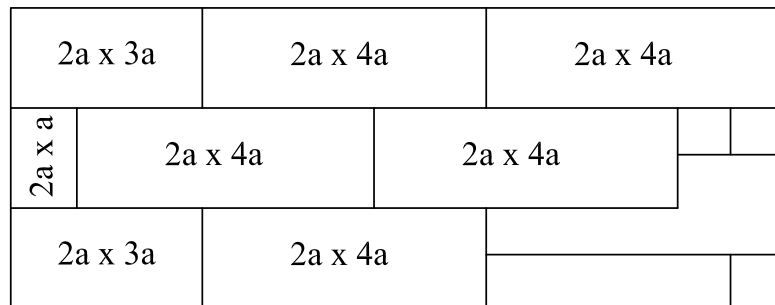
Раскладка пенополистирольных плит 2-го слоя
